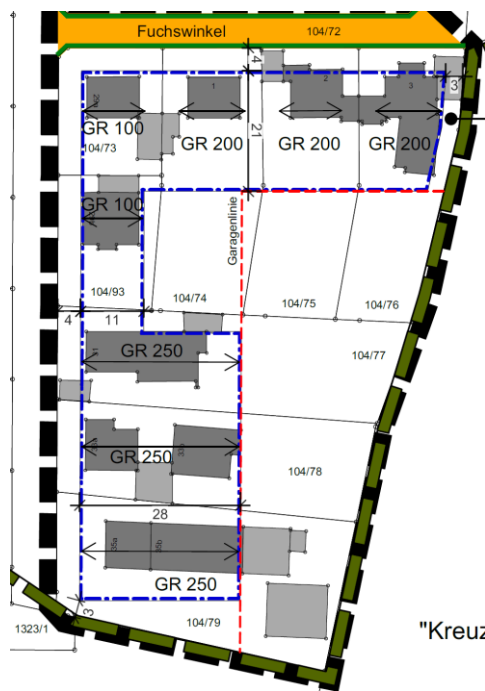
Bebauungsplanvariante 1 - einzeilige Bebauung
